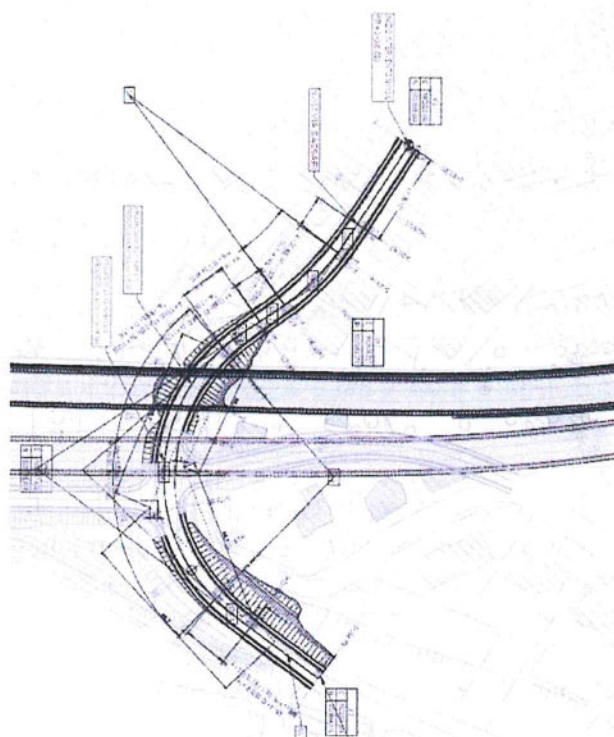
NV13 – Stralcio planimetrico su rilievo Via Brigata Sassari
